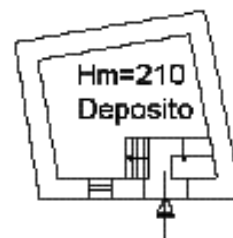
STRALCIO PLANIMETRICO DEL FABBRICATO INDAGATO – IN ATTI DAL 18.07.2002 – PROT.88.237/2002.
